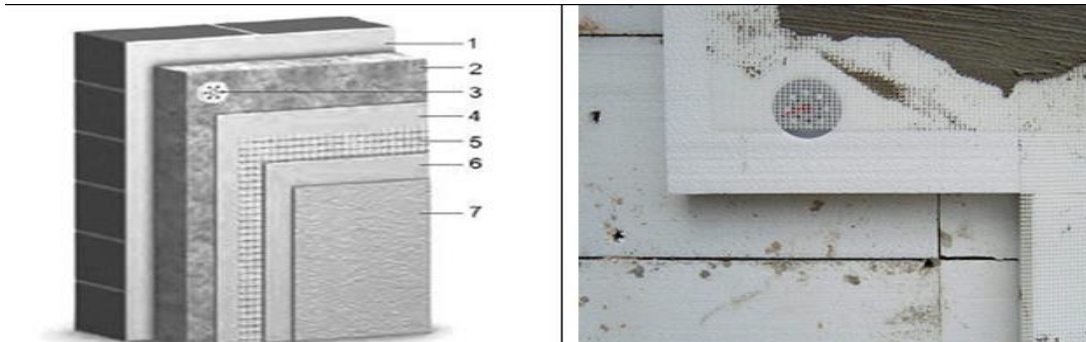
Фрагмент стіни утепленої методом «мокрого» фасаду. Де: 1-полімерно-цементний клей; 2-утеплювач; 3-дюбель тарілчастий; 4-базовий шар клею; 5-сітка фасадна; 6-покриваючий шар клею; 7- декоративний шар з ґрунтовкою.
